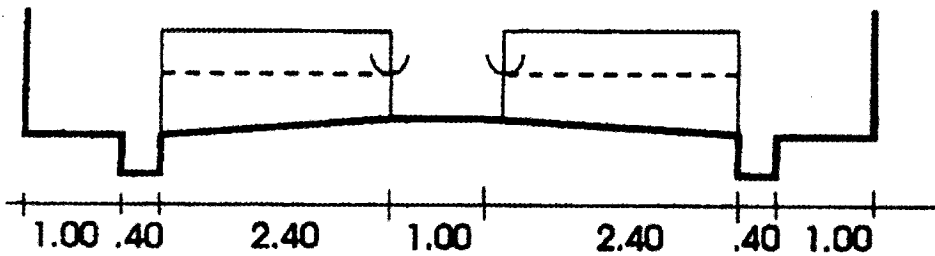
Corte transversal del piso para naves de precebo donde se utilizan jaulas metálicas con piso enrejillado.
